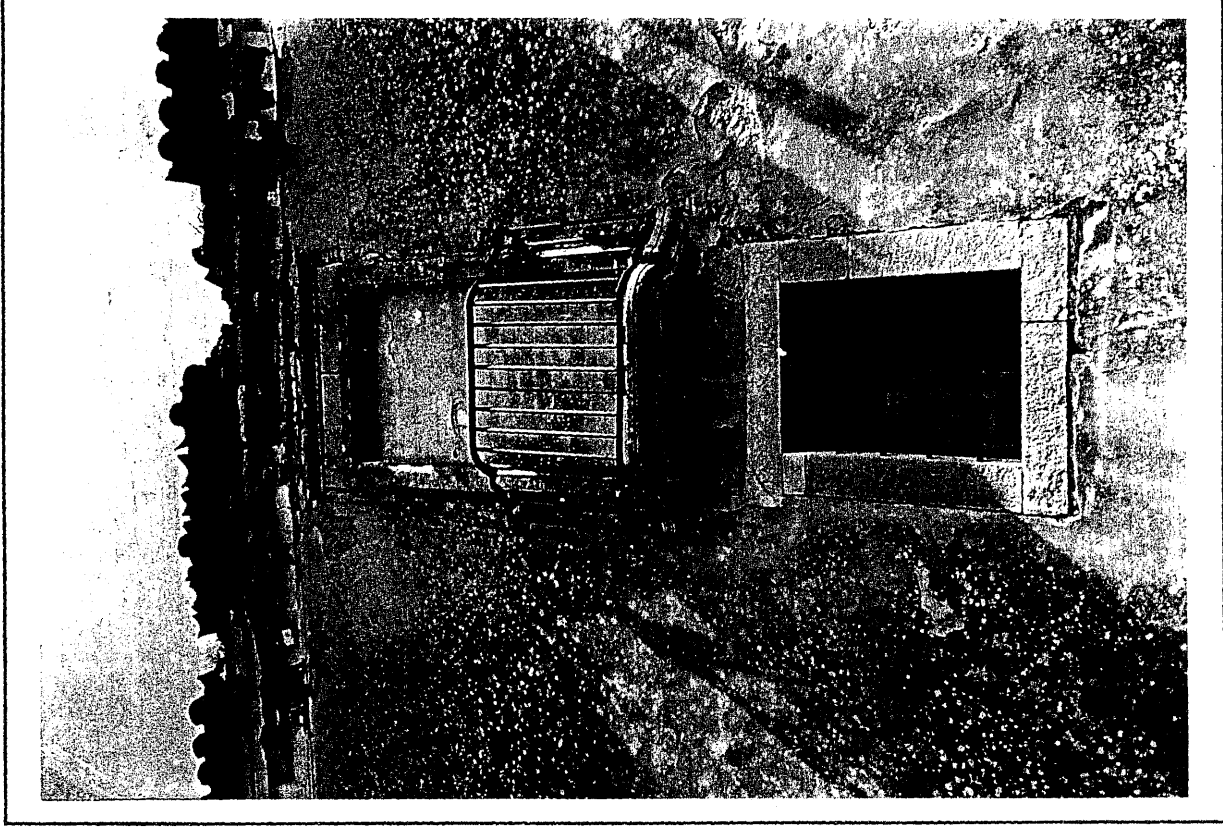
CASCINA PANARI PARTICOLARE ELEMENTI
